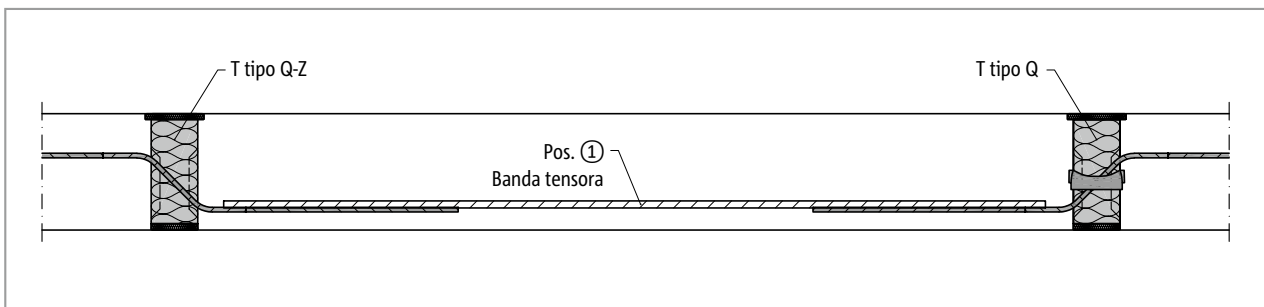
Schöck Isokorb® T tipo Q-Z-V6 hasta Q-Z-V12, Q-V6 hasta Q-V12: Sección A-A; losa de hormigón armado tensada sobre un eje
